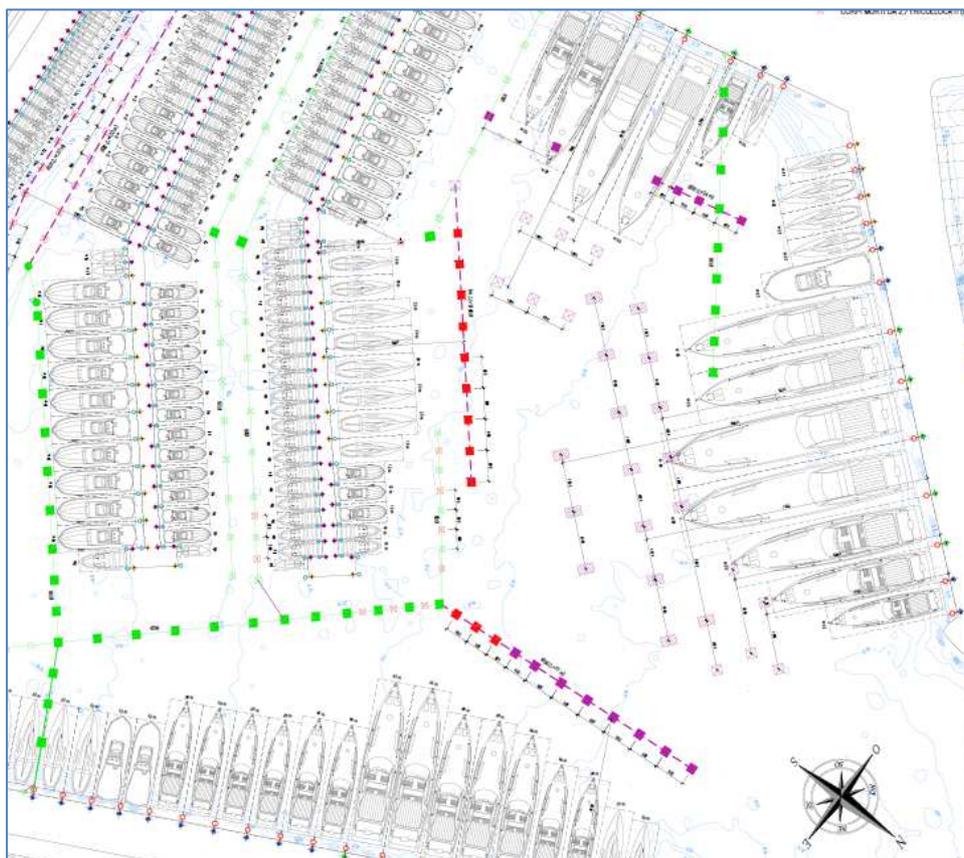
Stralcio Tav. V3-D07-00 – Planimetria sistemi di ormeggio a mare
